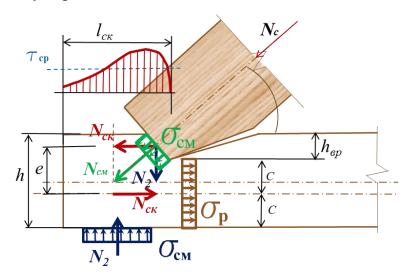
Лобовая врубка в опорных узлах брусчатых ферм, несущих узловые нагрузки
